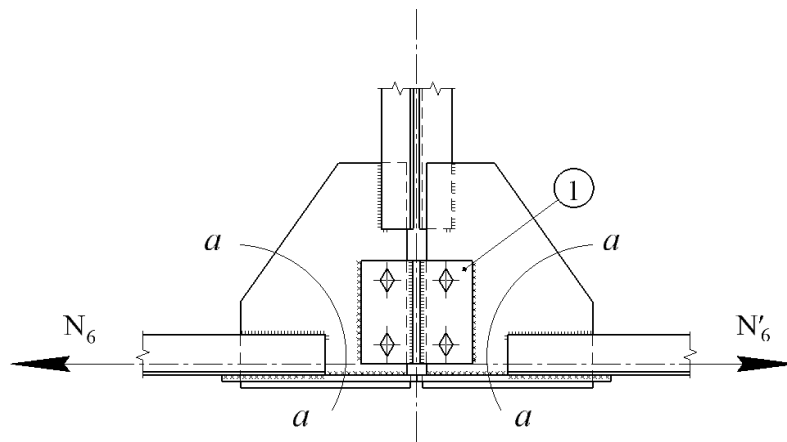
Вариант монтажного стыка марок нижнего пояса фермы
